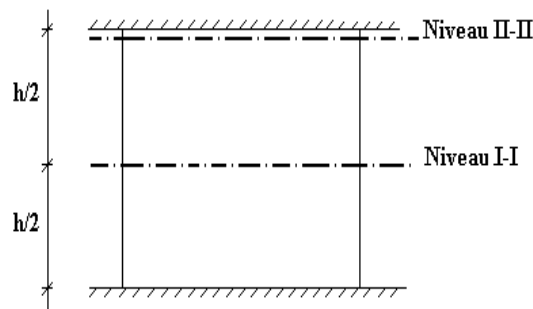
Schéma d'un voile plein et disposition du ferrailage
